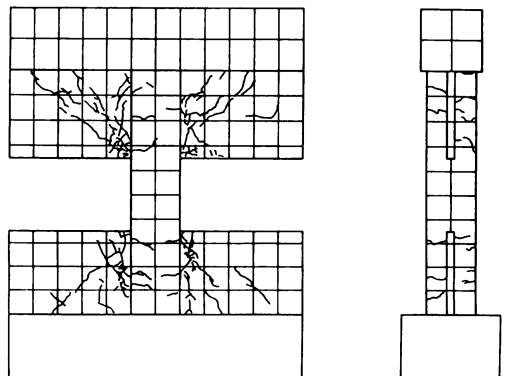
(c) 試験体 CSS03 の最大耐力時のひび割れ図
